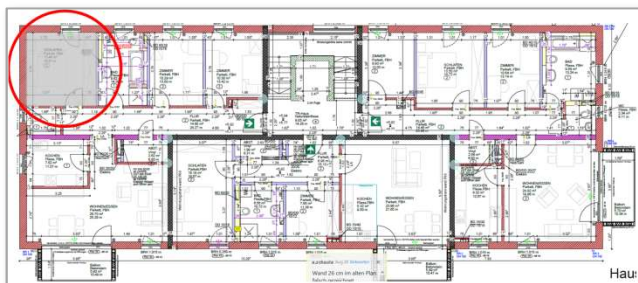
Grundriss eines Mehrfamiliengebäudes.
